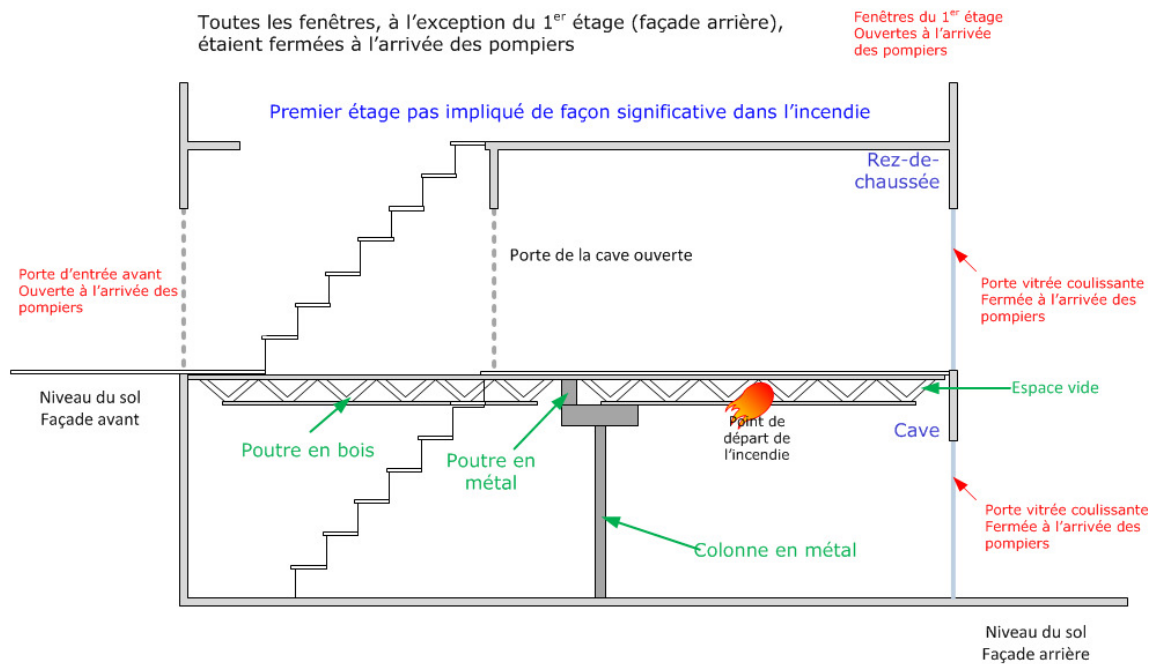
Coupe transversale de l'immeuble. La façade côté rue se trouve à gauche sur le schéma. La façade arrière avec la cave au niveau du jardin se trouve à droite
